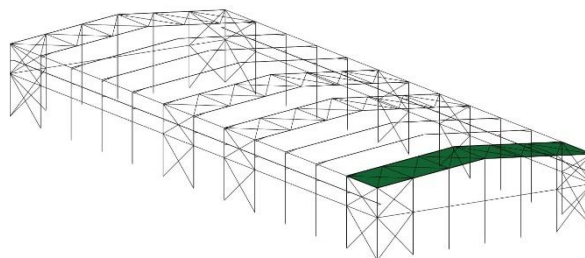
Viga contraviento. Fuente: Elaboración propia
